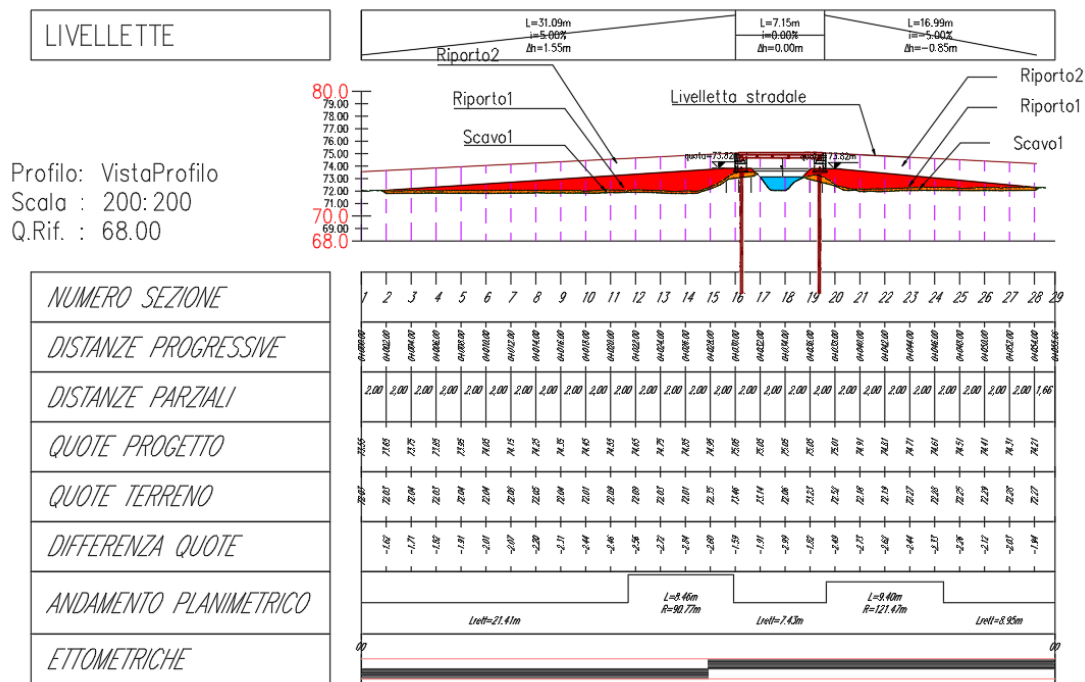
Profilo altimetrico – Ponte pedonale 1D
